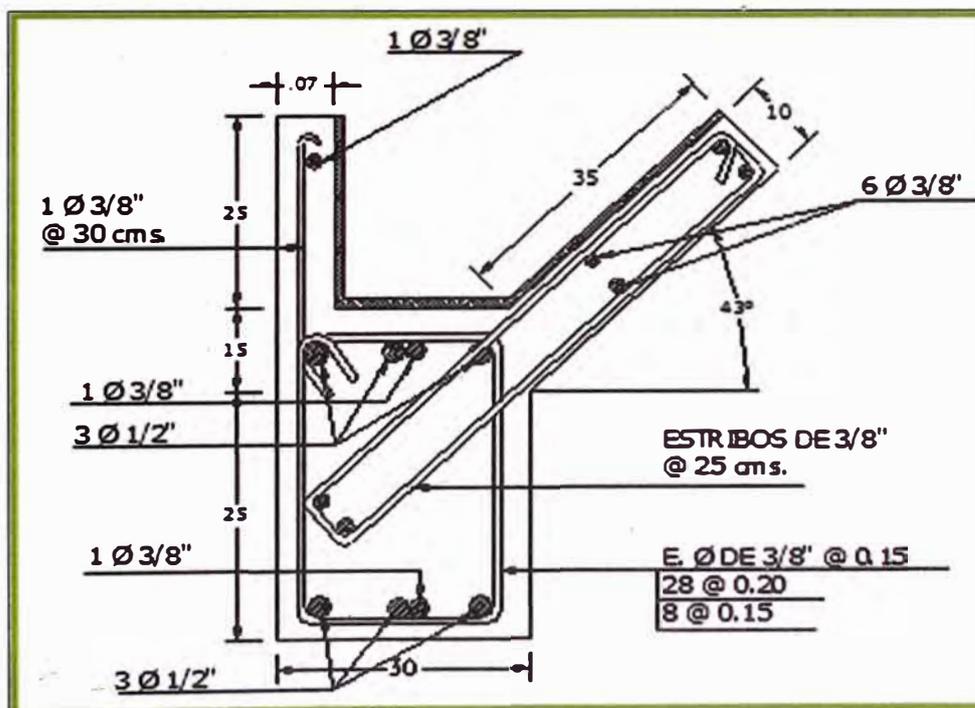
Viga canal de concreto forma simple (Referencia 3)
